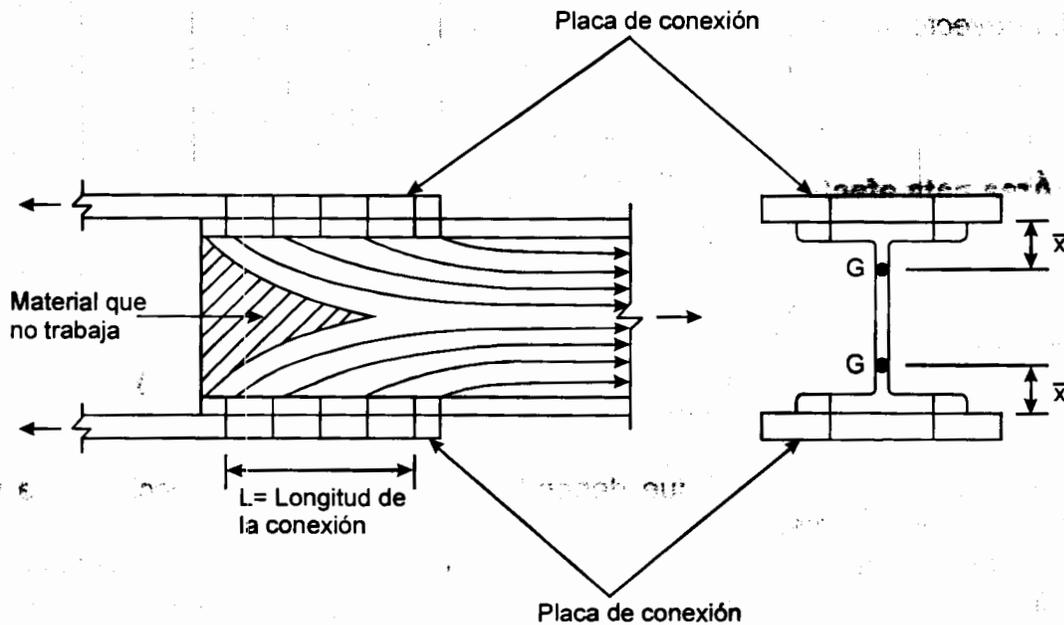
Distribución de esfuerzos en una sección "H" conectada por los patines.
